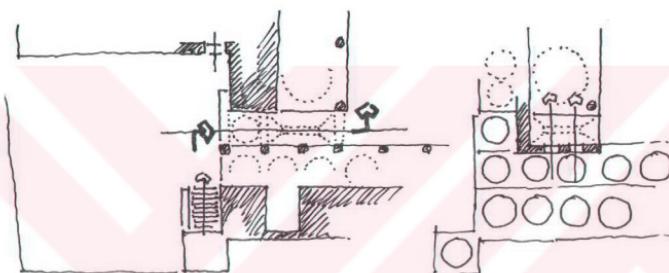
Vaziyet planı (ŞİMŞEK 1987, şek. 29'dan: çizim: A.S. ÜLGEN)
